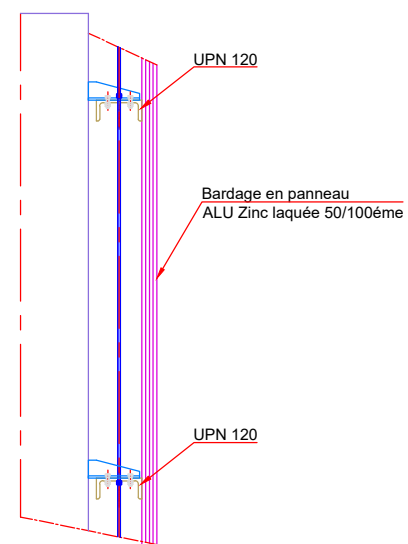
DETAIL FIXATION POTEAU CM SUR POTEAU BA
